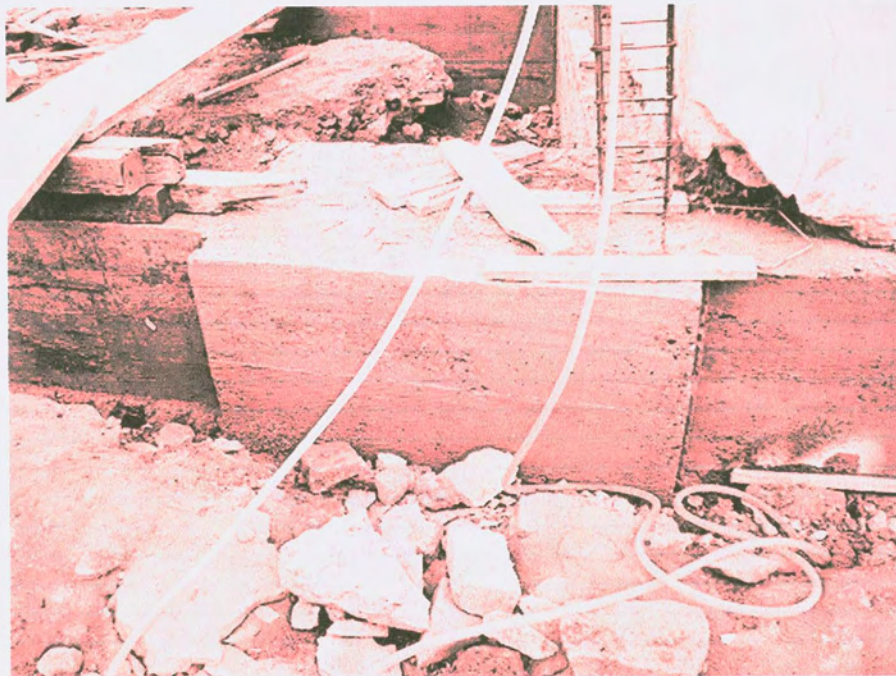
Detalhe do setor bloco-vigas já concretado.
